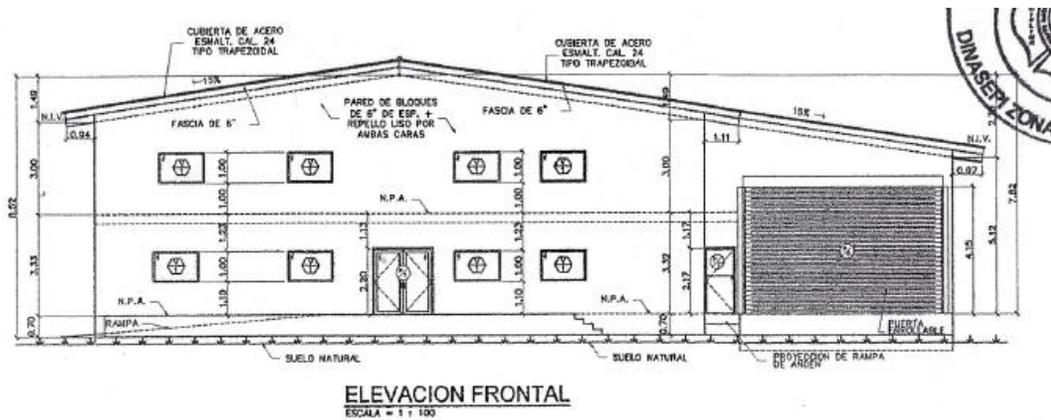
Vista elevación frontal de la Galera a construir. Fuente: Planos del Proyecto.
